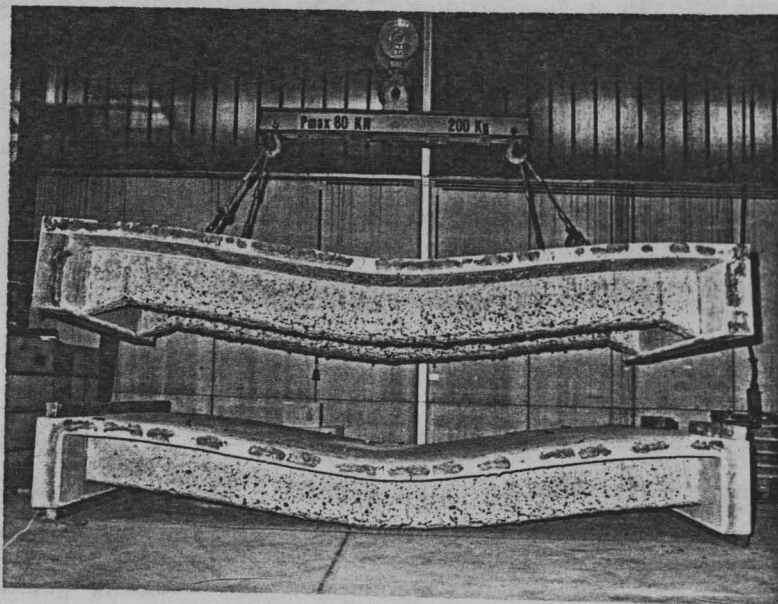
Dehnbehinderte Stahlbeton- π -Platten
